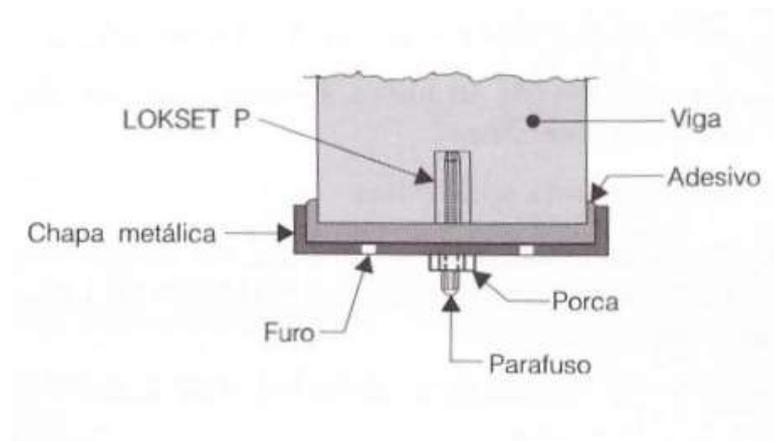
Chapas metálicas aderidas com epóxi (HELENE, 1992)
